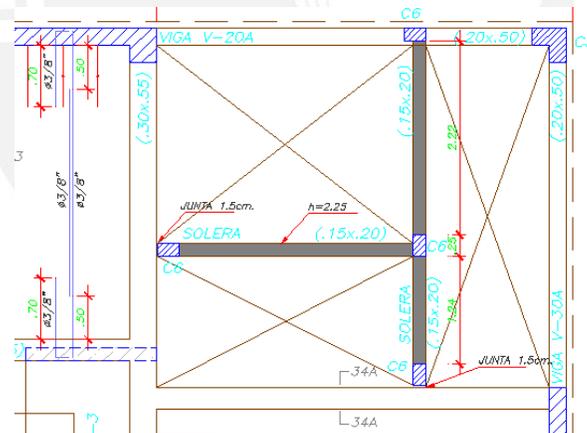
Albañilería – Ubicación de Columnas de Amarre.
